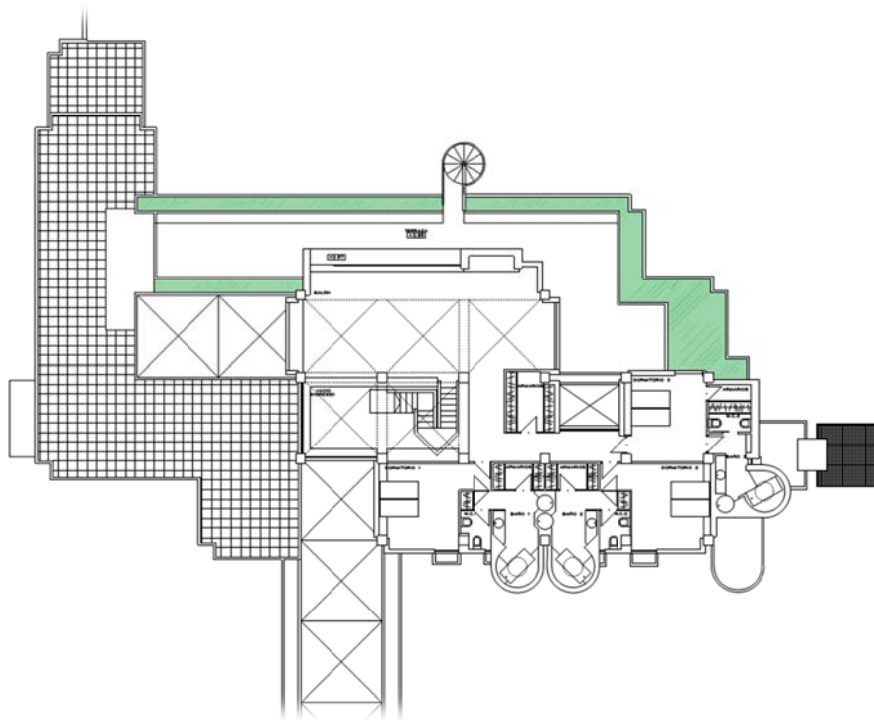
y 7. Plantas Baja y Alta. C/B Arquitectos.2004
